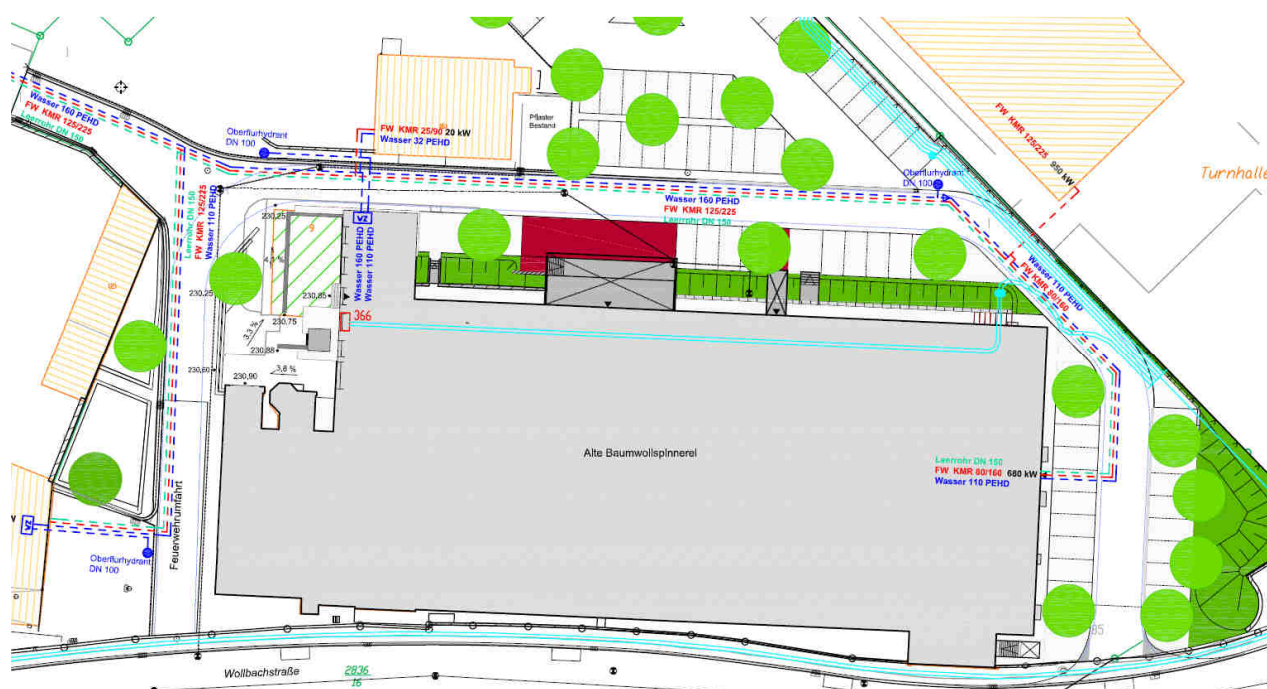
Übersicht Lageplan Versorgungsleitungen (Dienstbarkeiten)
